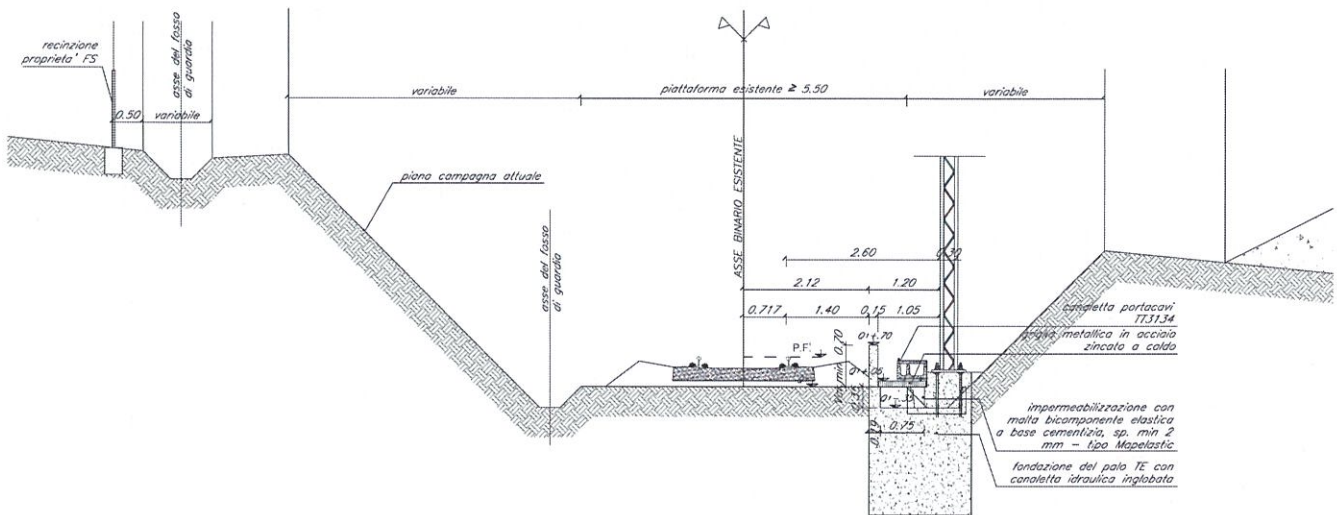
Tratta Cervaro - Candela. Sezione tipo in trincea
